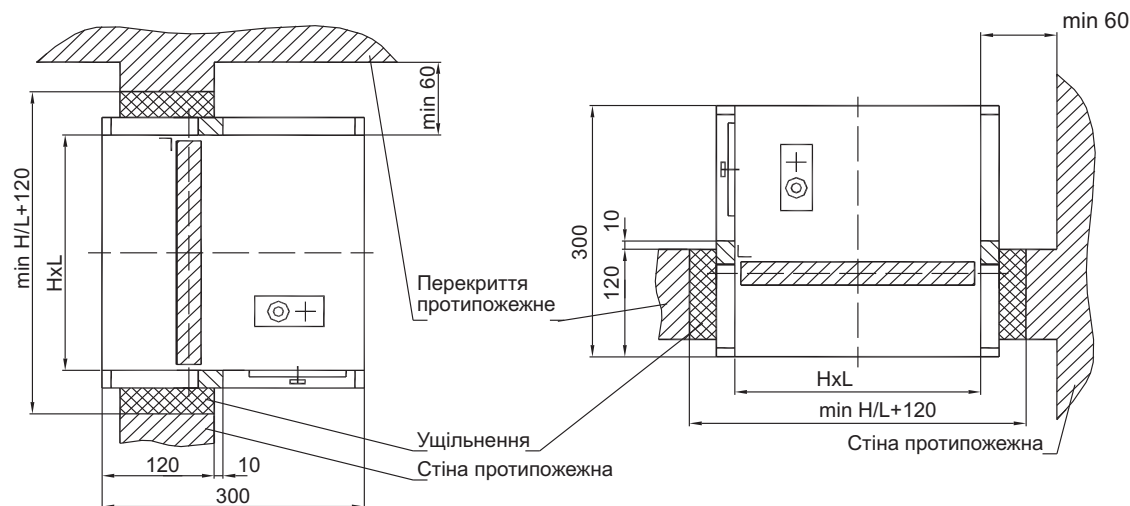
Схема монтажа клапана КПВ прямоугольного сечения в ограждающих конструкциях
